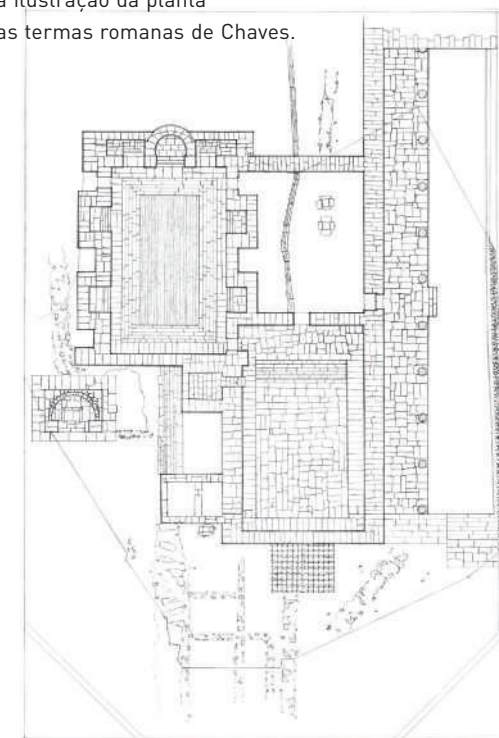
Ilustração final da planta das termas medicinais romanas de Chaves.
